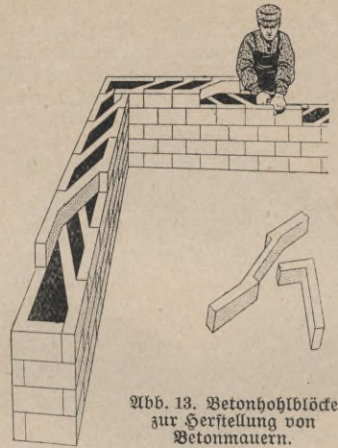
Betonhohlböcke zur Herstellung von Betonmauern.
